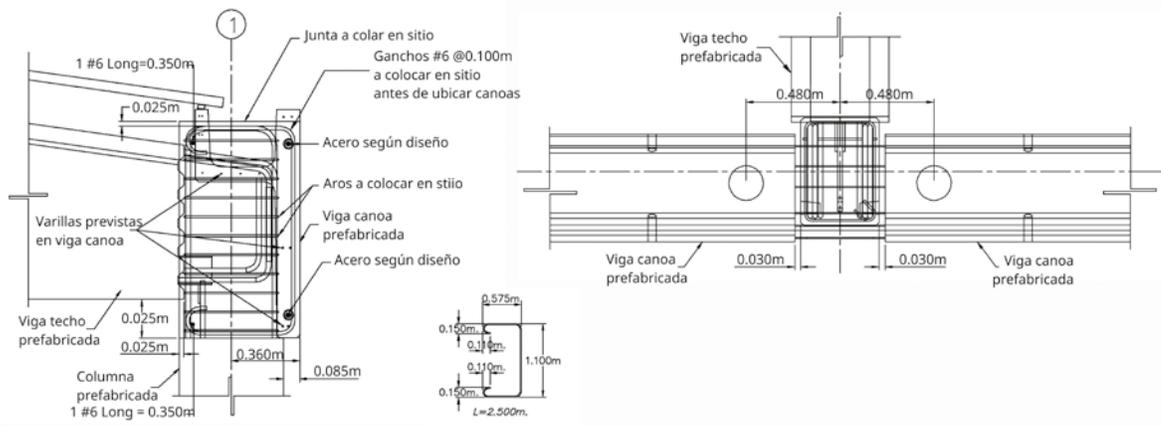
Detalles típicos de conexión viga canoa - columna
